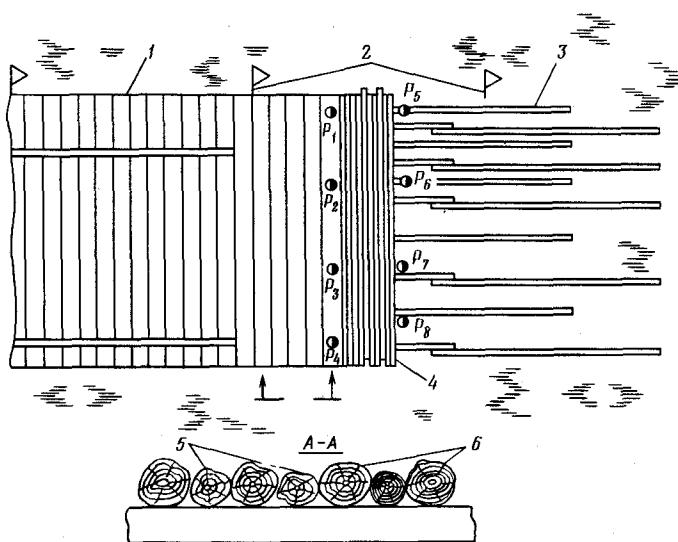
Схема организации работ по укладке лаг поперечного настила (накатника):
